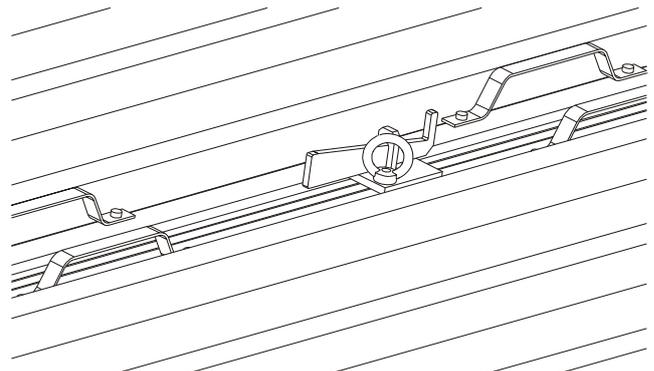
Spannplatten mit angeschweißter Ringmutter
